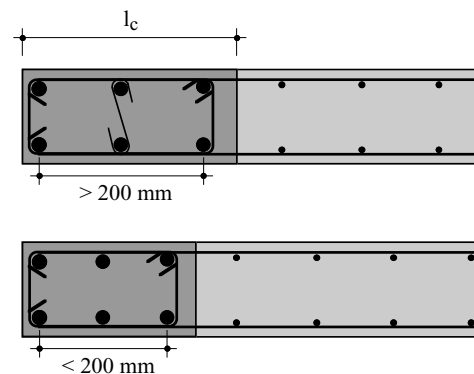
Stabilisation des barres longitudinales dans la zone plastique.
